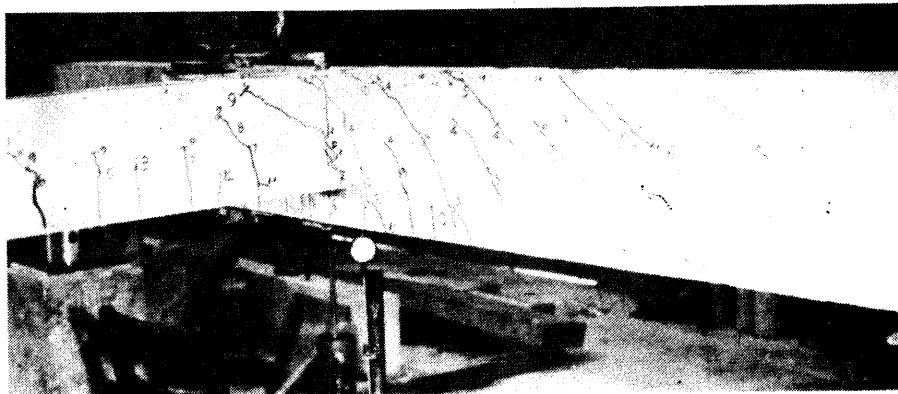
Tampak dekat retak pada balok yang ada dalam Foto 42. (Atas izin Thomas T.C. Hsu.)
